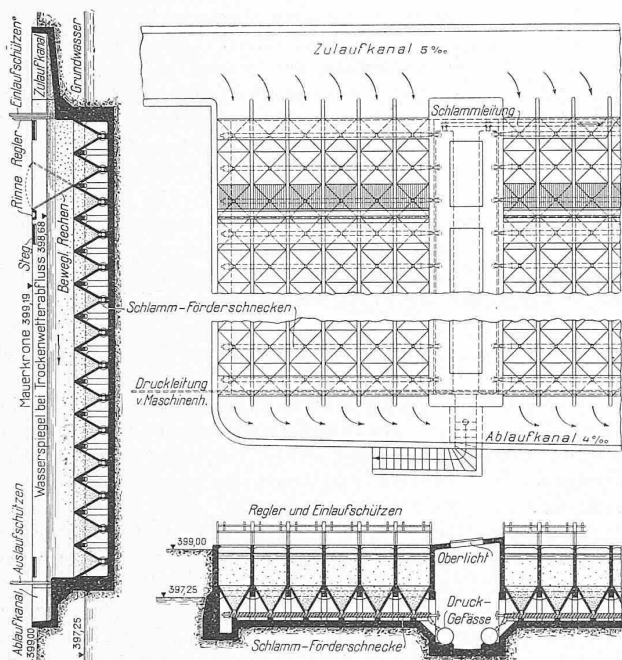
Grundriss und Schnitte der Klärrinnen. — 1 : 250.
